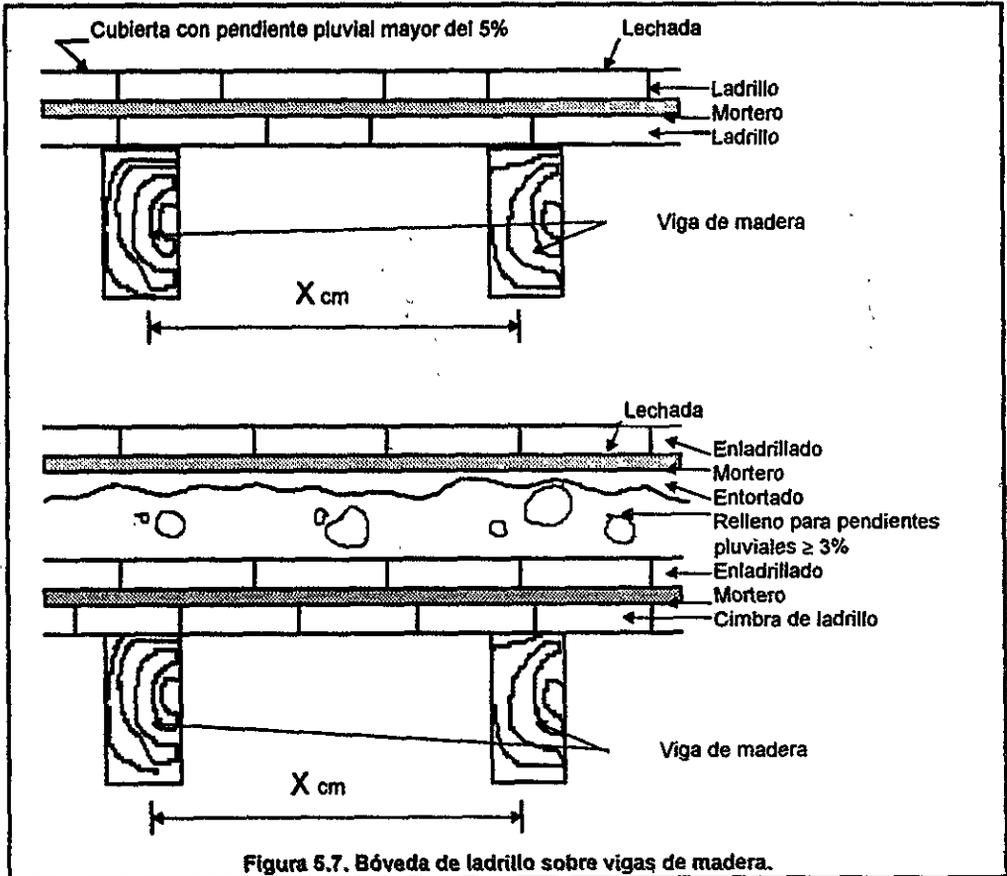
Bóveda de ladrillo sobre vigas de madera.
